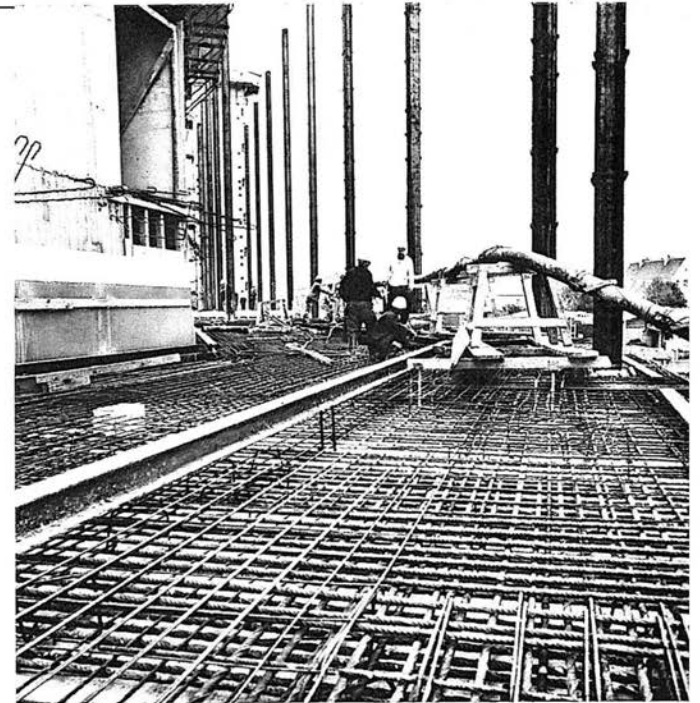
Betonieren der Hubdecke mittels Betonpumpe
